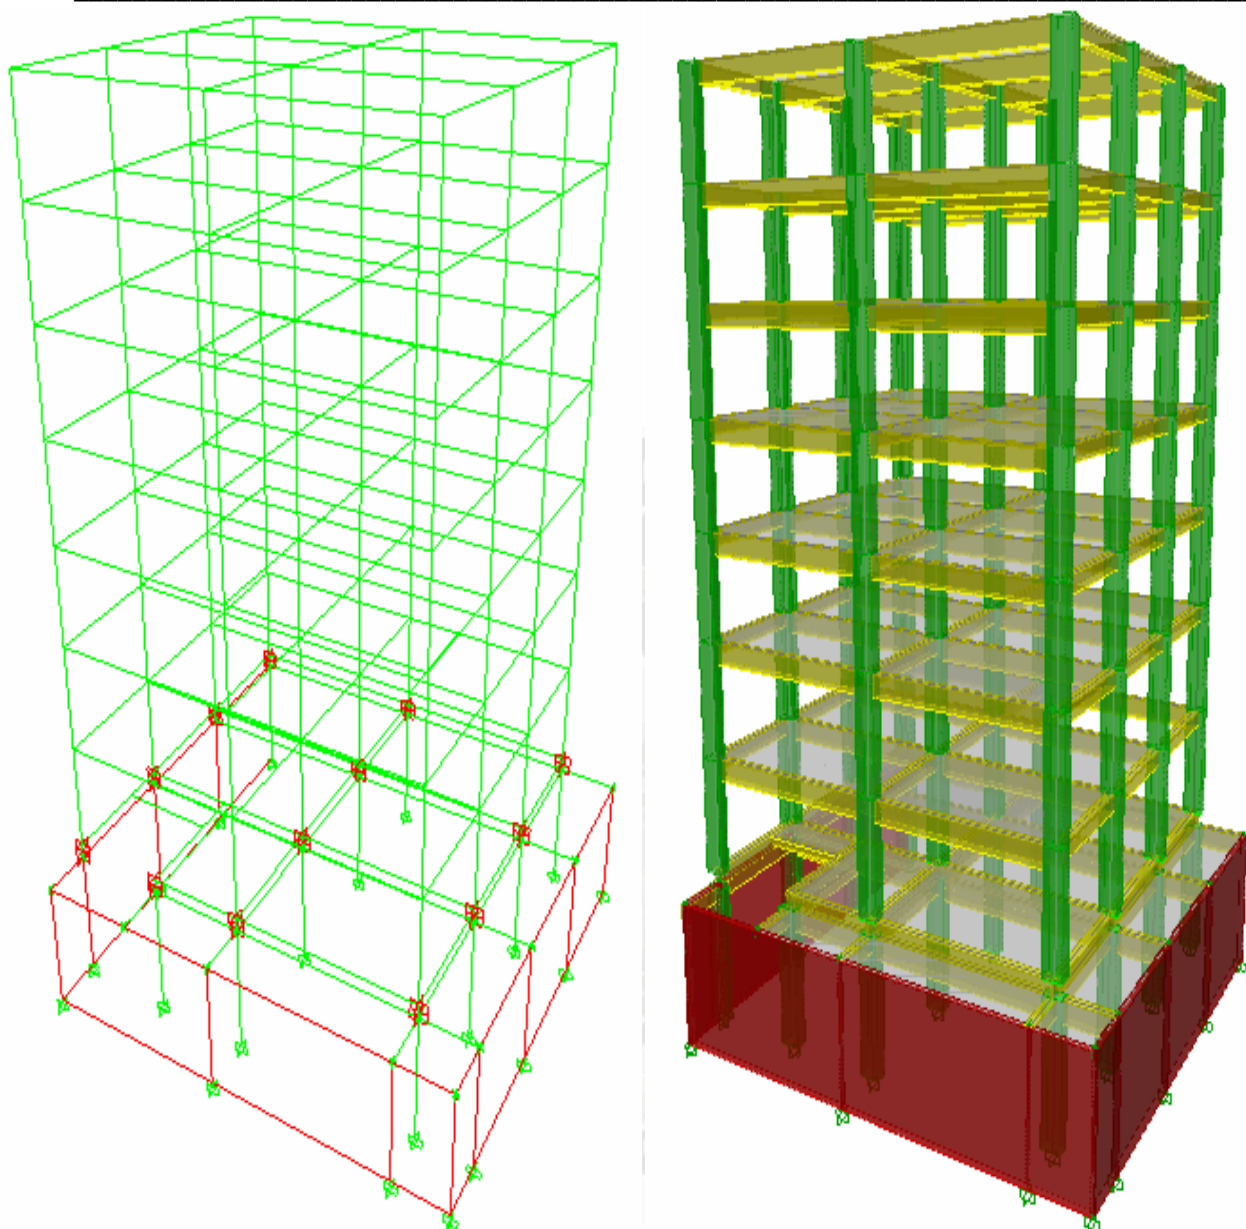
Vista tridimensional (modelo aislado)
